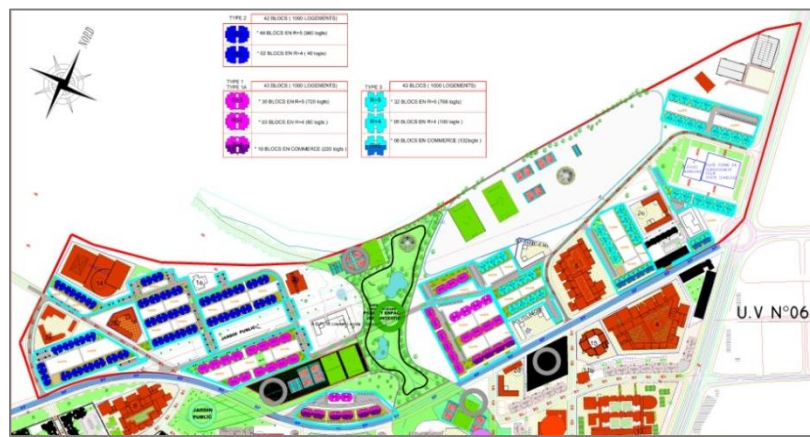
plan de masse UV 16 réalisé après 2011 (Source :OPGI)
